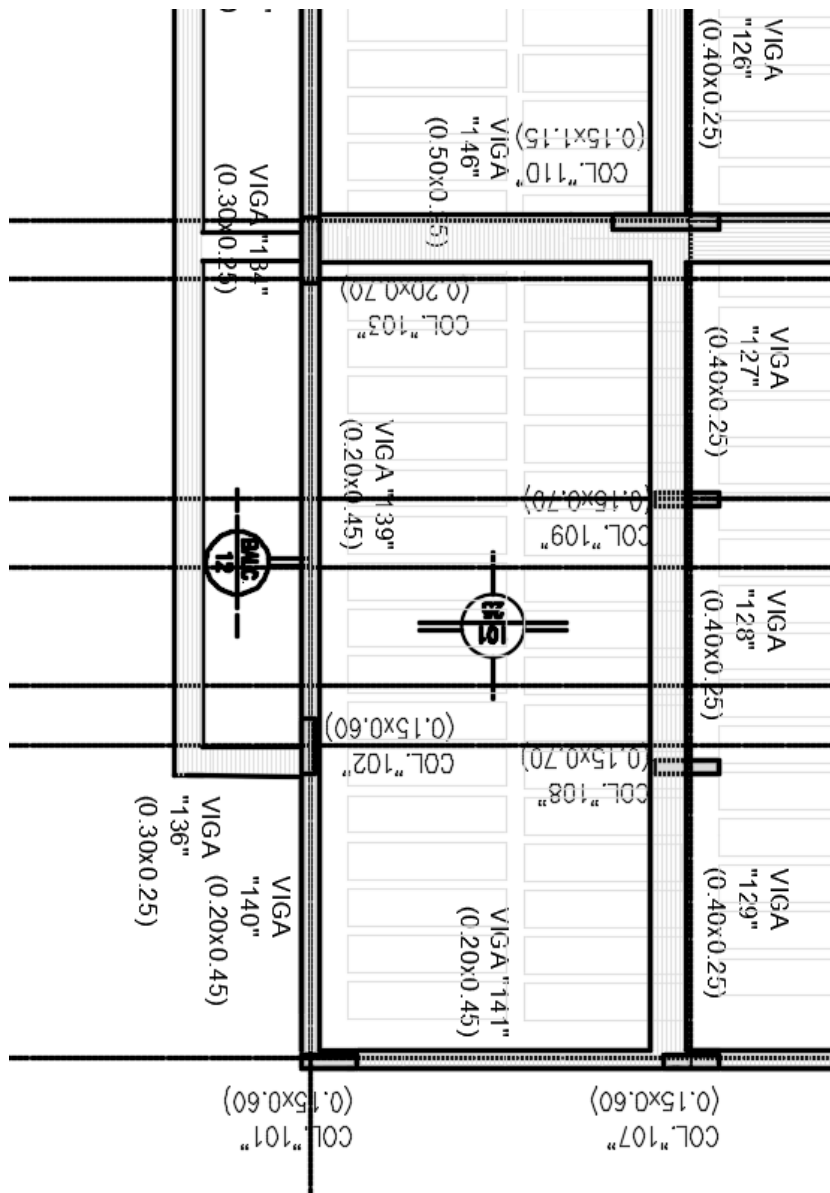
Plano con las dimensiones de los elementos estructurales.
